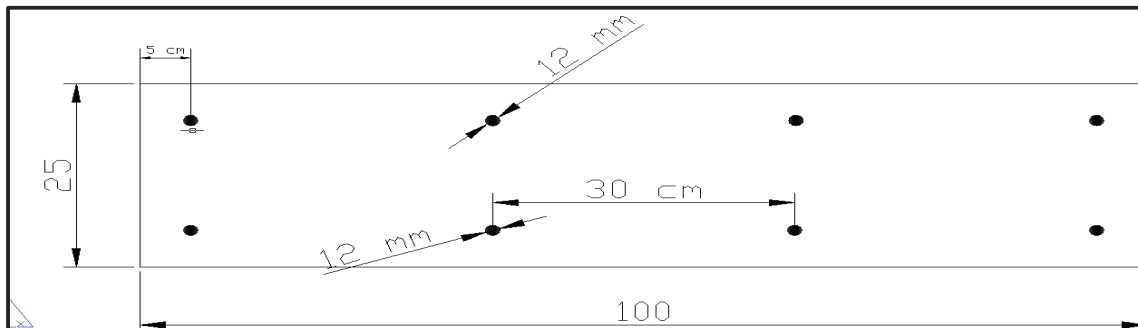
Schéma de ferrailage longitudinal de la dalle.
